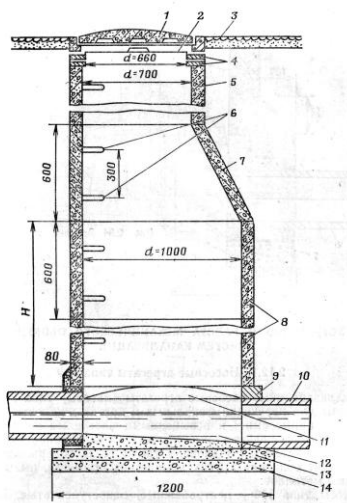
Сборный железобетонный круглый смотровой колодец:
